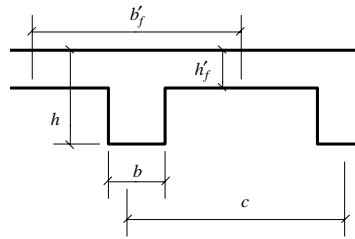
Визначення таврового перерізу у монолітному балковому перекритті
